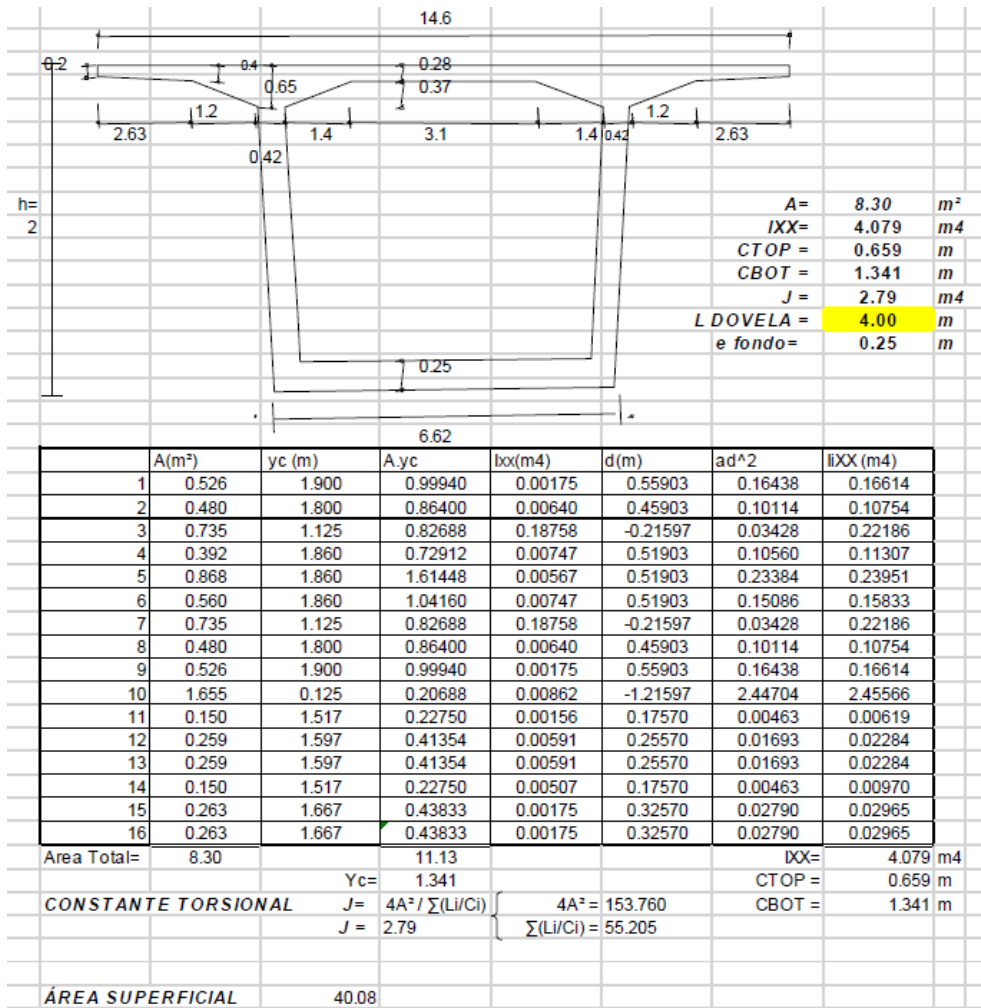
Dimensiones y propiedades de la viga cajón cara menor dovela 10 puente San Pedro.
